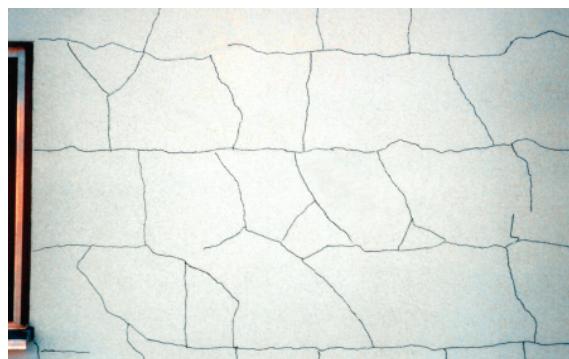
Putzrisse (nachgezeichnet) im Außenputz auf Mauerwerk aus Leichtziegeln (Versuchshaus). An der Maueröffnung rechts ist zu erkennen, dass der Horizontalriss einer Lagerfuge folgt, wie auch der obere Riss. Die vertikalen Risse entsprechen Stoßfugen, davon abweichend einige Kerbrisse.
